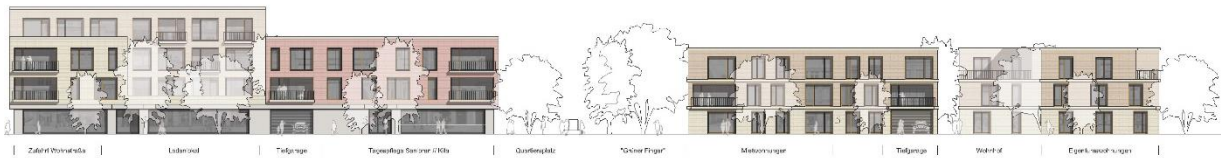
Vorentwurf | Ansicht Wohnstraße © LECKE ARCHITEKTEN
